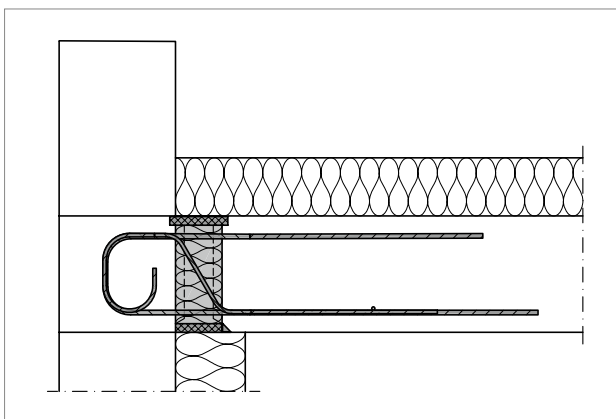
Schöck Rutherma® T type DF*i* : liaison dans la zone de l'acrotère
